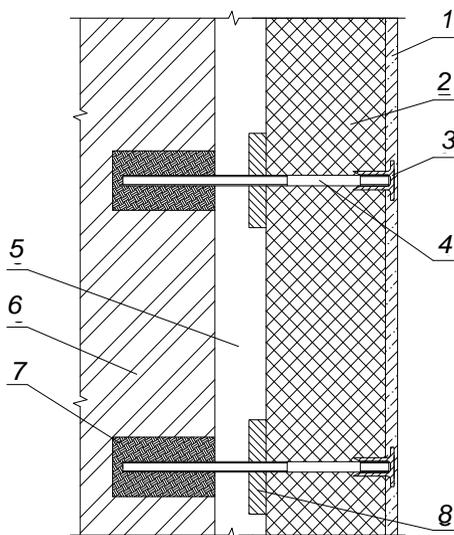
Конструкция системы утепления стен «Термический экран»:
